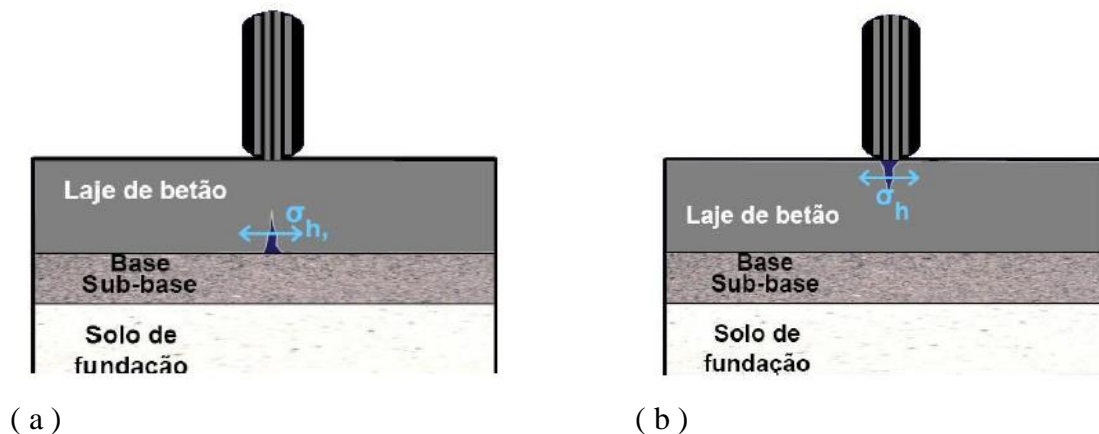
Fendilhamento por fadiga ( a ) na base da laje de betão; ( b ) no topo da laje de betão. (LNEC and IST 2005)
